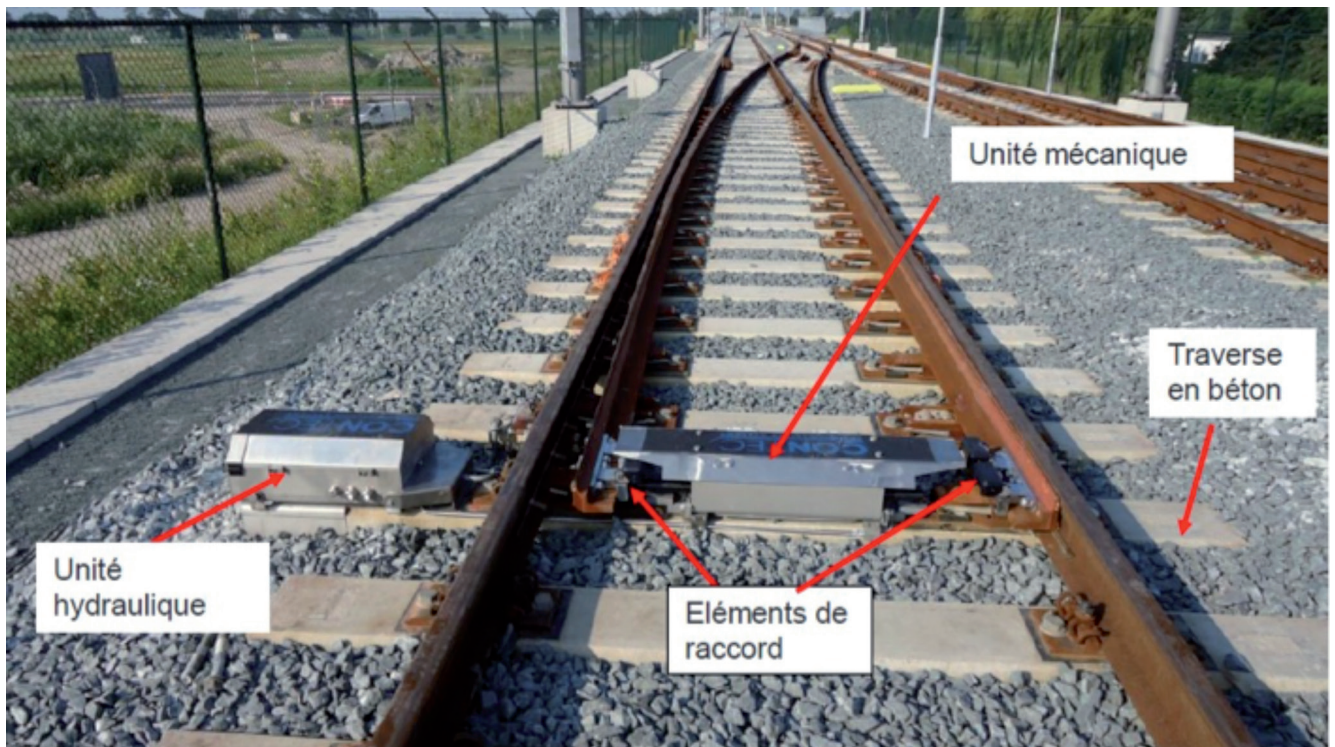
Exemple d'une Installation moteur entre rails en aérien
